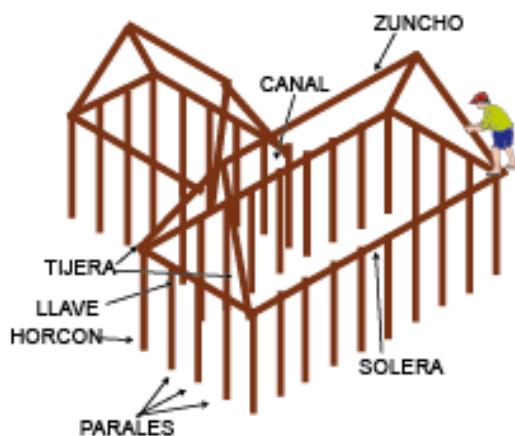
Entramado de la Estructura, Fuente adaptado de (Wilches, 2009)
